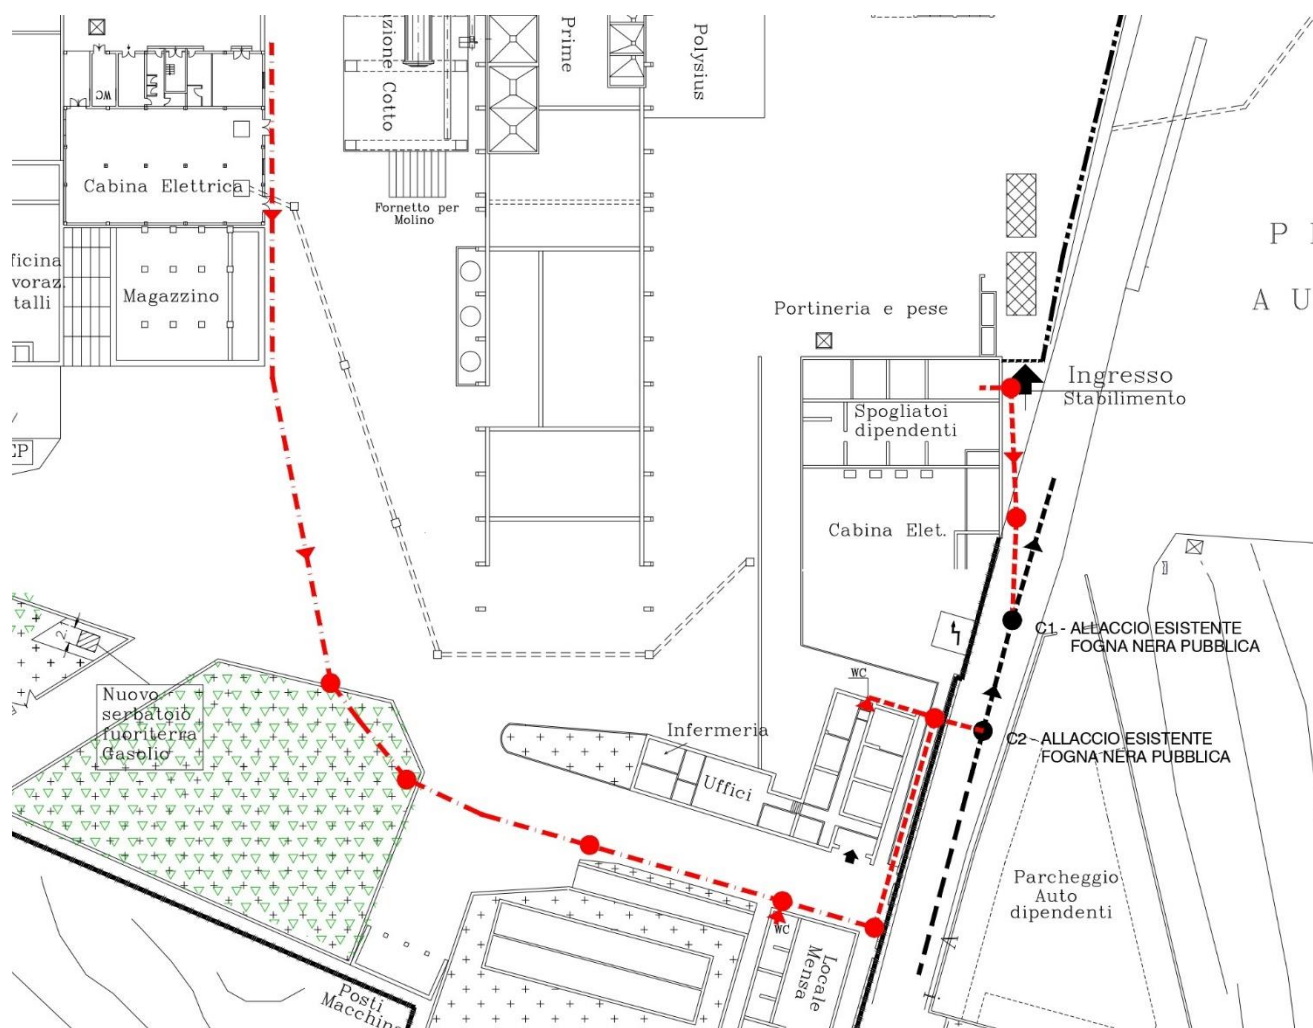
stralcio planimetria delle reti reflui civili esistenti
